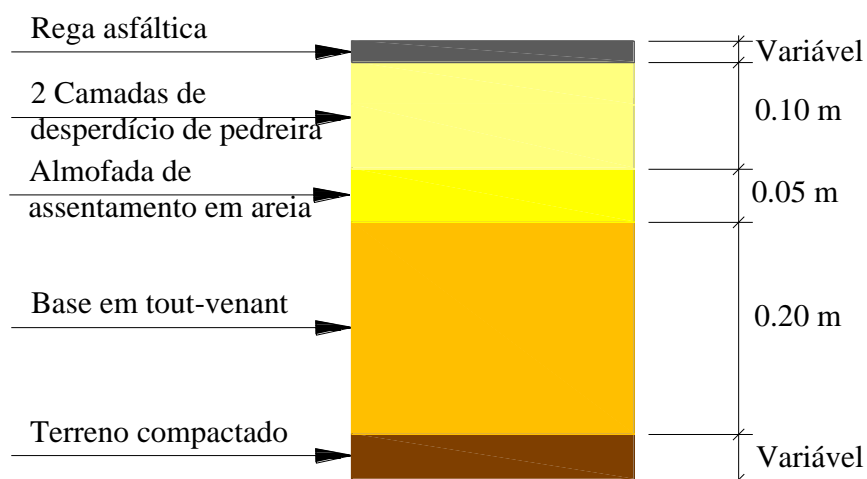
Estrutura do pavimento da zona A, adaptado de (Moreira, 1992).
